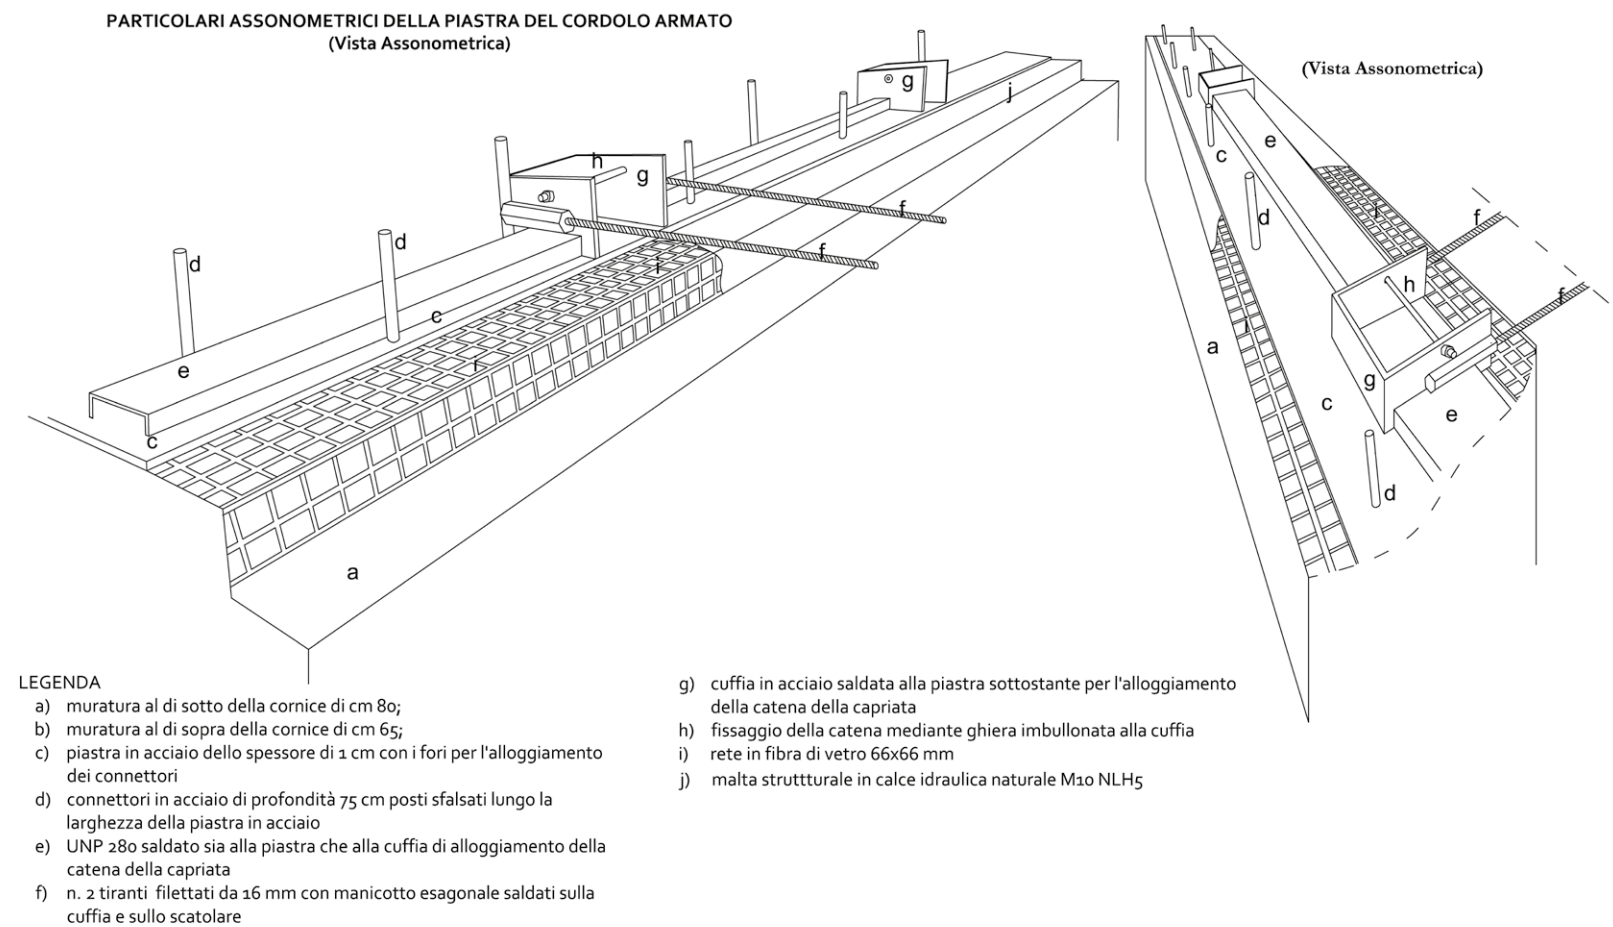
Realizzazione di piastra e cordolatura in profilati metallici - vista prospettica
